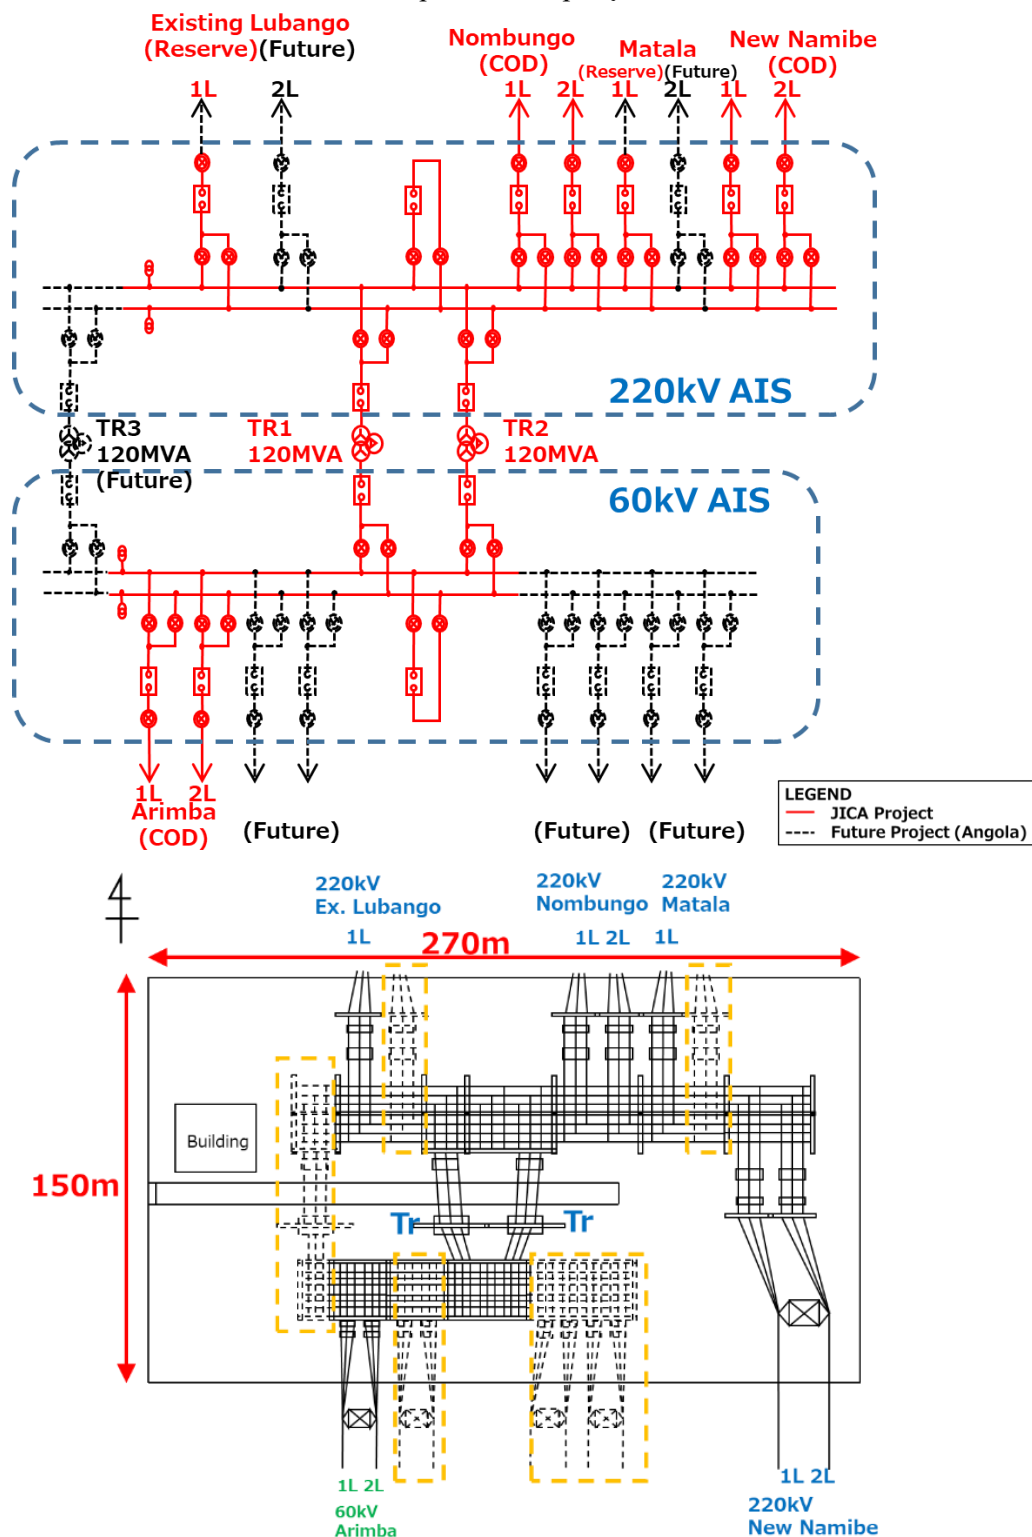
Diagrama unifilar e a proposta geral de layout da subestação Leste Lubango
